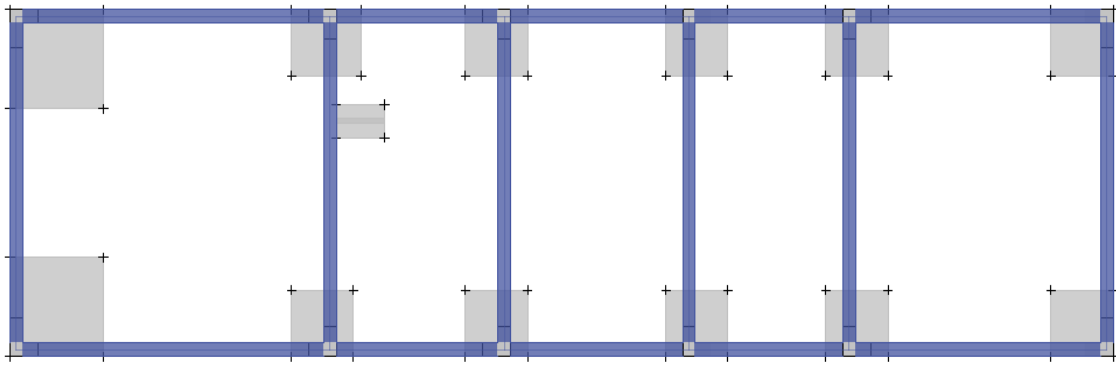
Análisis de la Sub Estructura del Sistema estructural Tradicional– Vista en planta.
